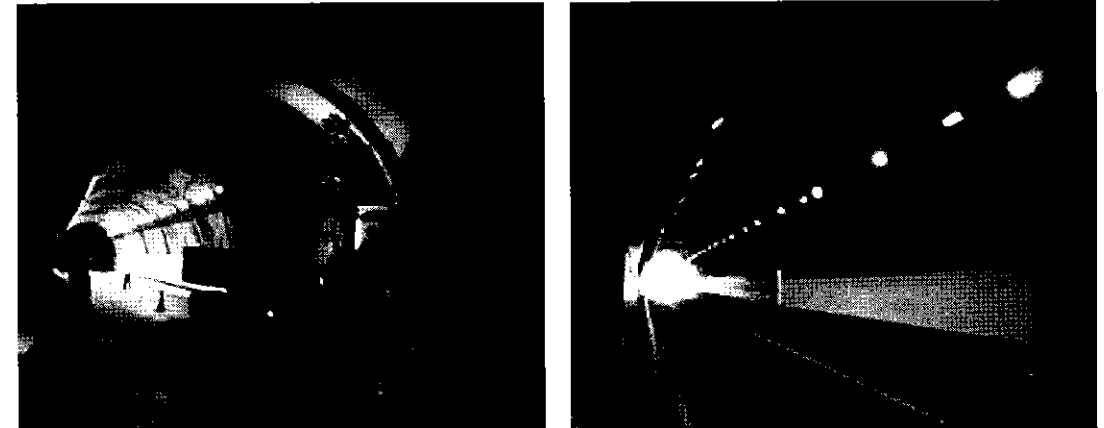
プレキャスト工の施工状況および完成状況⁴⁾
